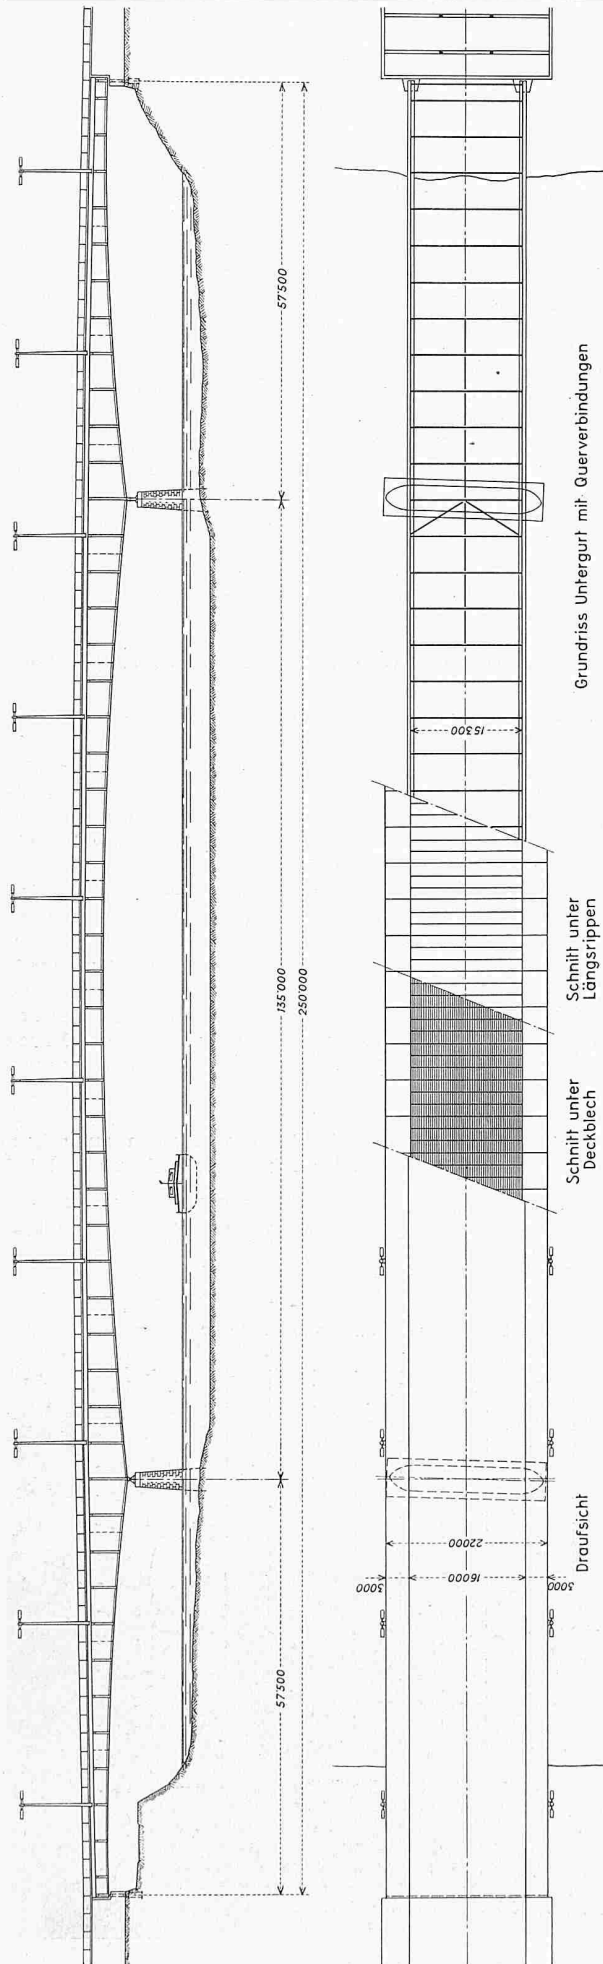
St. Albanbrücke. Oben Ansicht, unten Grundriss, 1:1000
